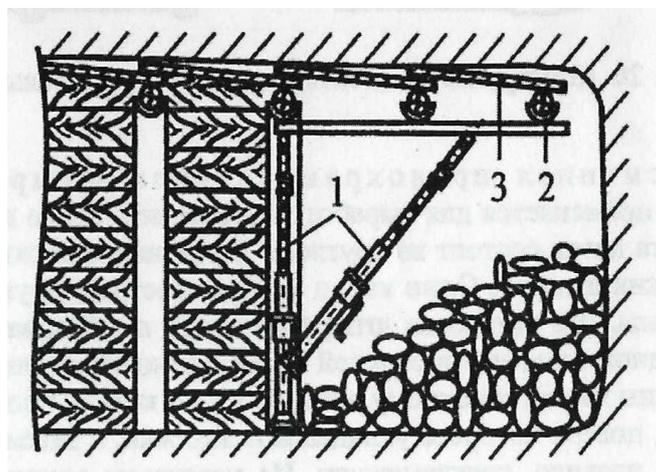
Предохранительная консольная крепь конструкции ВостНИИ.
